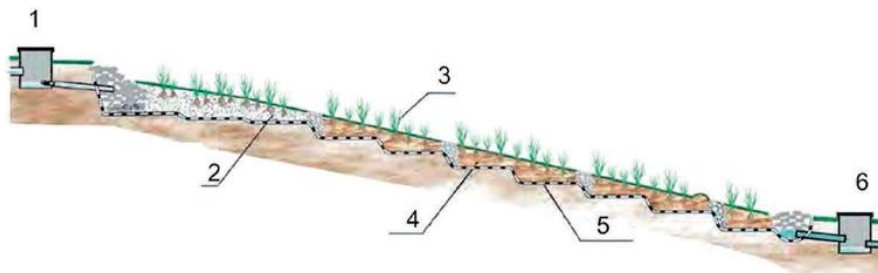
Схема грунтово-растительной площадки с наклонным потоком:
